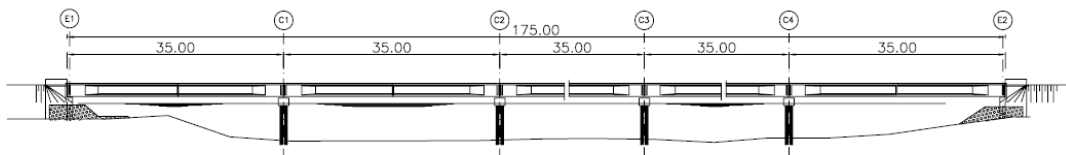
Puente Pullally Calle de Servicio
